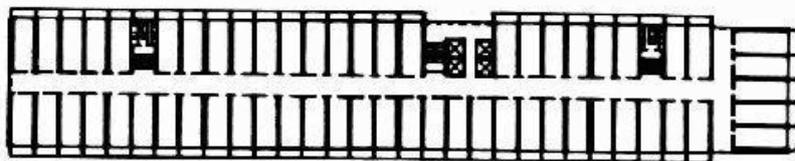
PLANTA BAIXA (UNITÉ D'HABITATION)
